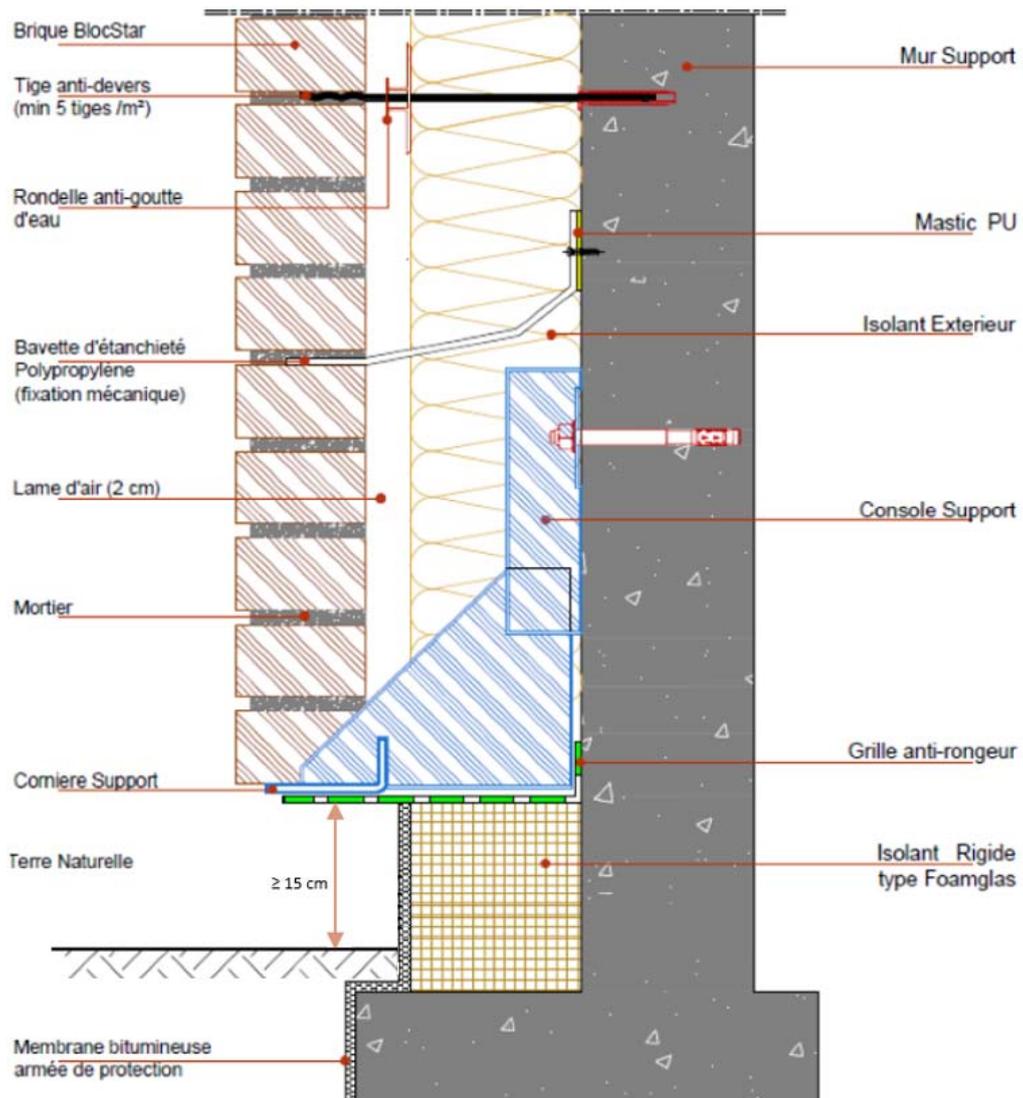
Appui du 1^{er} rang sur console de supportage (2 niveaux filants et 6 m maximum)
